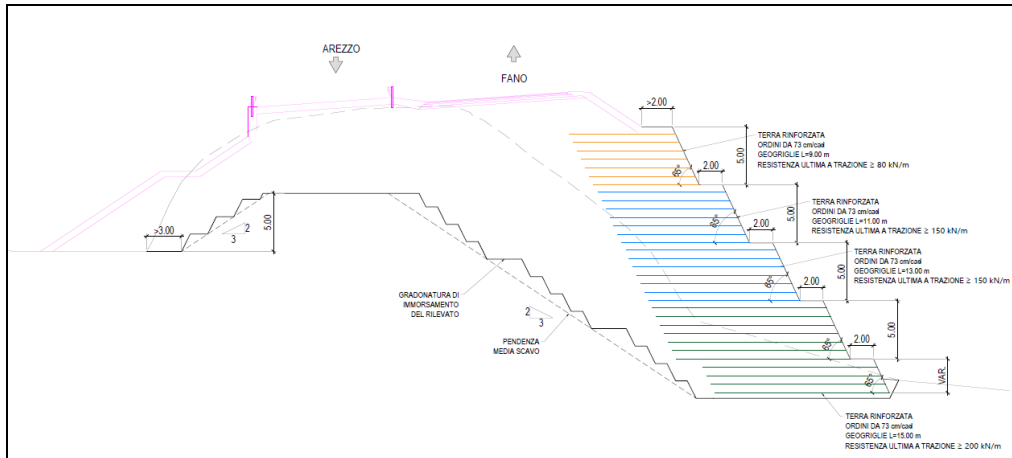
Sezione schematica del rilevato in terra rinforzata dalla pk 1+980 alla pk 2+110
